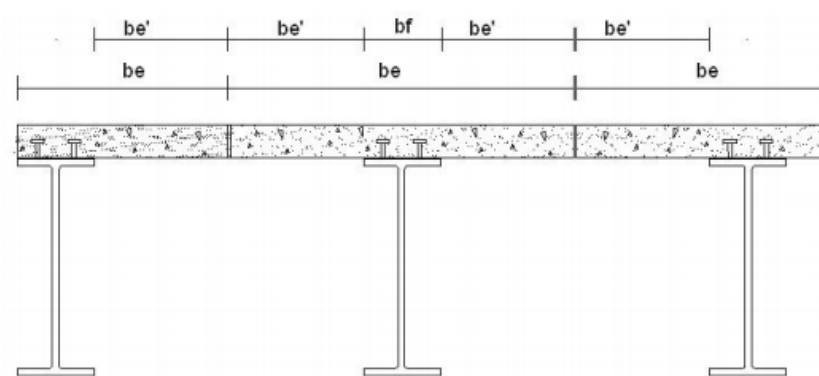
10 Ancho efectivo del tablero en vigas exteriores
